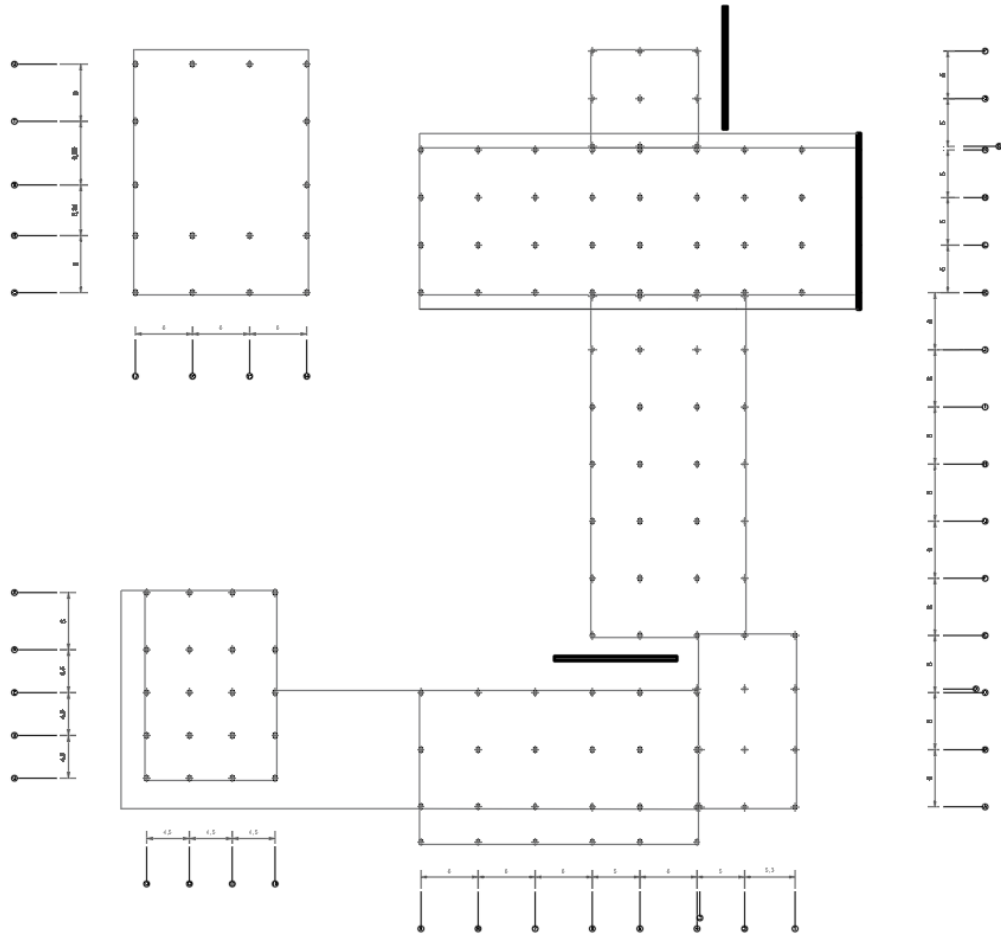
Estructura. Vista en Planta. Diagrama del autor.
